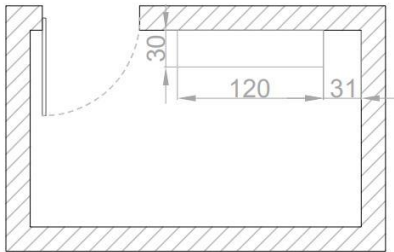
Planta de Equipamento Cotada Hall de Entrada
